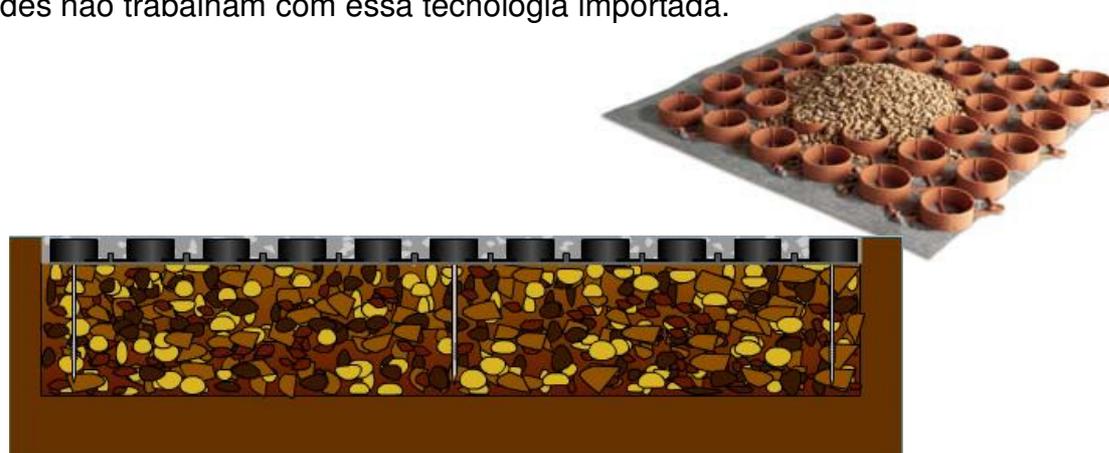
Figura XI: Foto e esquema da pavimentação porosa de cascalho.
